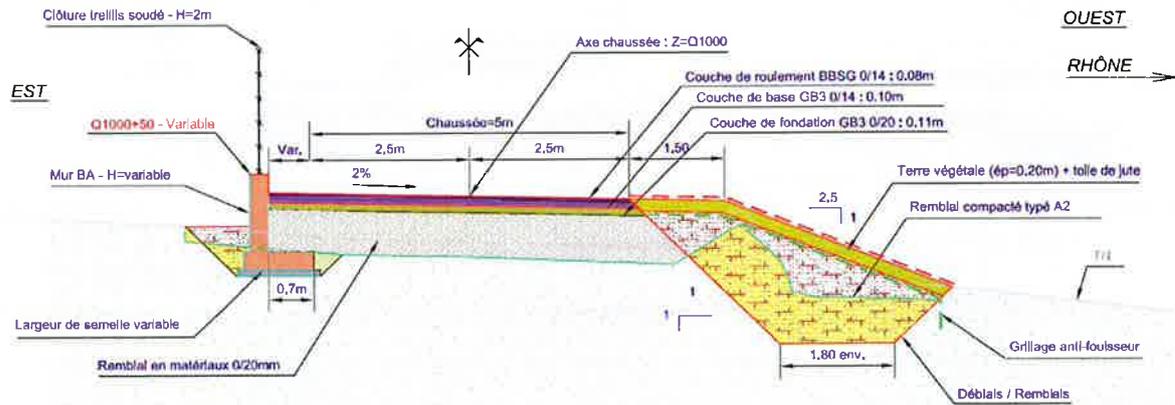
Coupe-type de la rehausse de voirie et de mur de soutènement au droit du remblai ferroviaire
